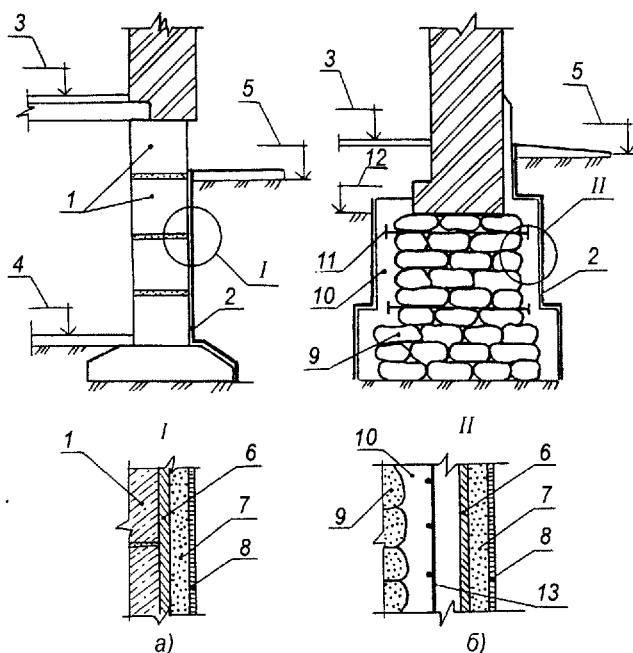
Схема устройства гидроизоляционного покрытия на боковой поверхности ленточных фундаментов: а – из сборных бетонных блоков; б – из бутового камня; 1 – подвальная бетонная стена из сборных бетонных блоков с гладкой боковой поверхностью; 2 – устраиваемое гидроизоляционное покрытие; 3 – отметка пола первого этажа здания; 4 – отметка пола подвала; 5 – отметка наружной поверхности земли; 6 – слой шпаклевки из известкового теста, либо слой обмазки из жидкого стекла; 7 – штукатурный слой из цементно-песчаного раствора с добавкой (модифицированный цементно-песчаный раствор); 8 – гладкое защитное стекловидное покрытие, контактирующее с окружающей средой; 9 – бутовая кладка фундамента; 10 – монолитная железобетонная обойма; 11 – анкеры из арматурной стали для надежного закрепления железобетонной обоймы; 12 – отметка поверхности земли внутри здания; 13 – сетка из арматурной стали, устанавливаемая при устройстве монолитной железобетонной обоймы
